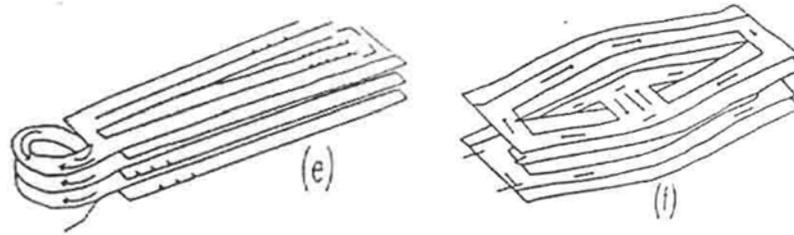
Pola Parkir dengan Lantai Terpisah (split)
